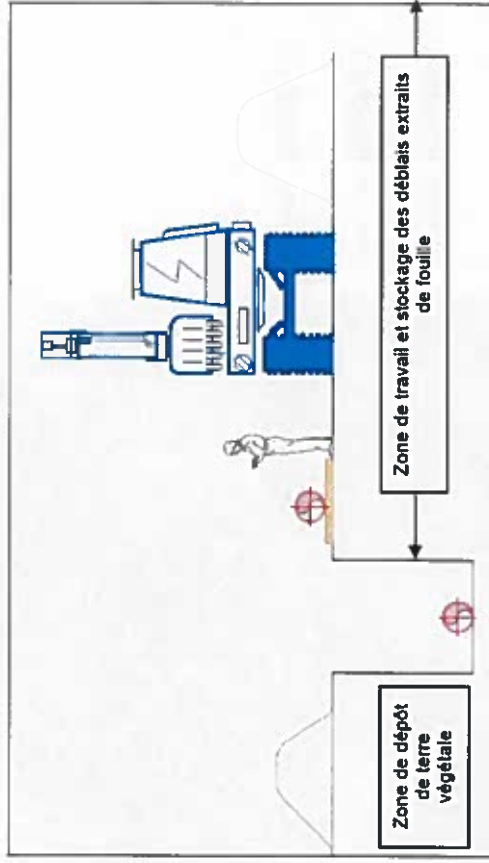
Schéma d'organisation type pour la mise en place d'une canalisation
